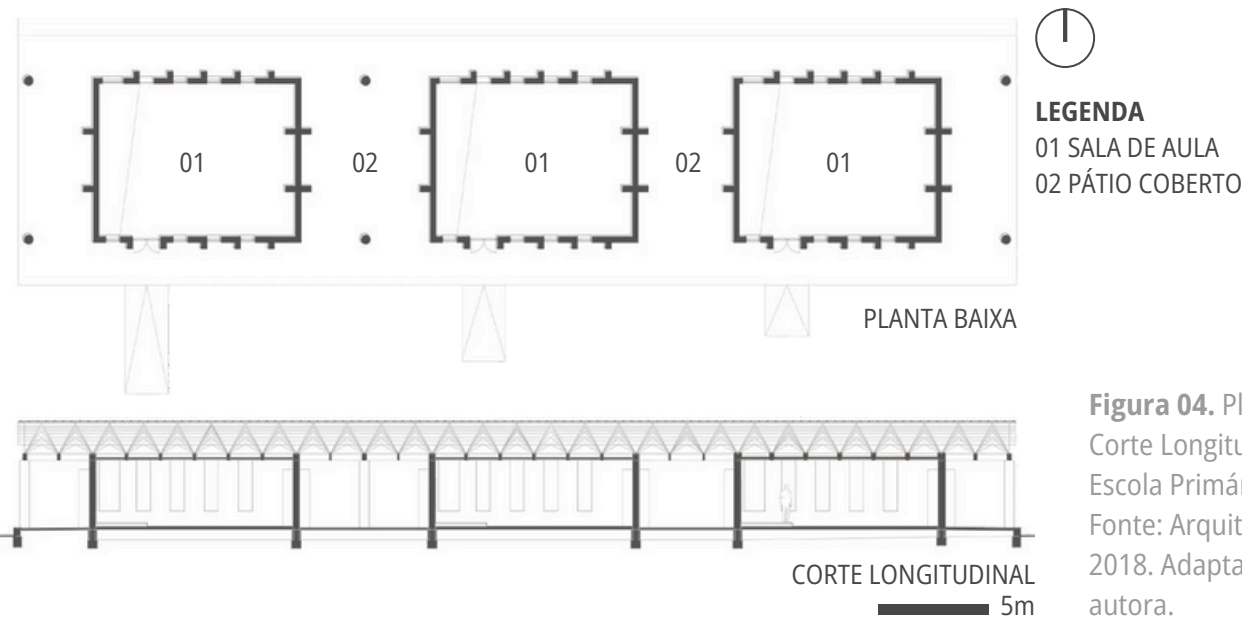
Planta Baixa e Corte Longitudinal da Escola Primária de Gando. Fonte: Arquitectura Viva, 2018. Adaptado pela autora.
